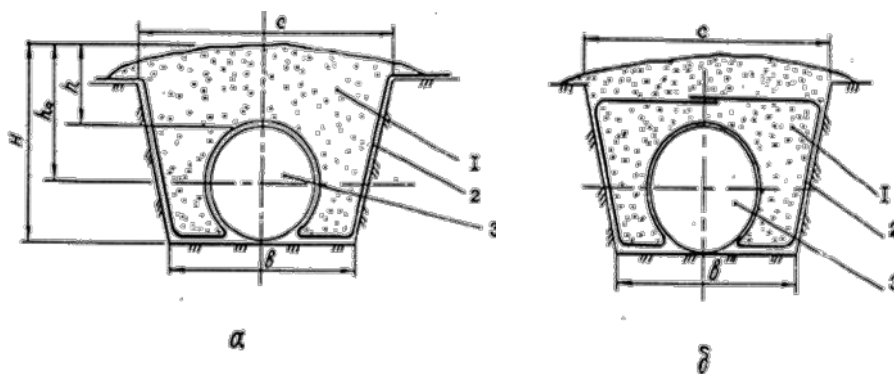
Схемы балластировки трубопроводов грунтом с применением НСМ:
